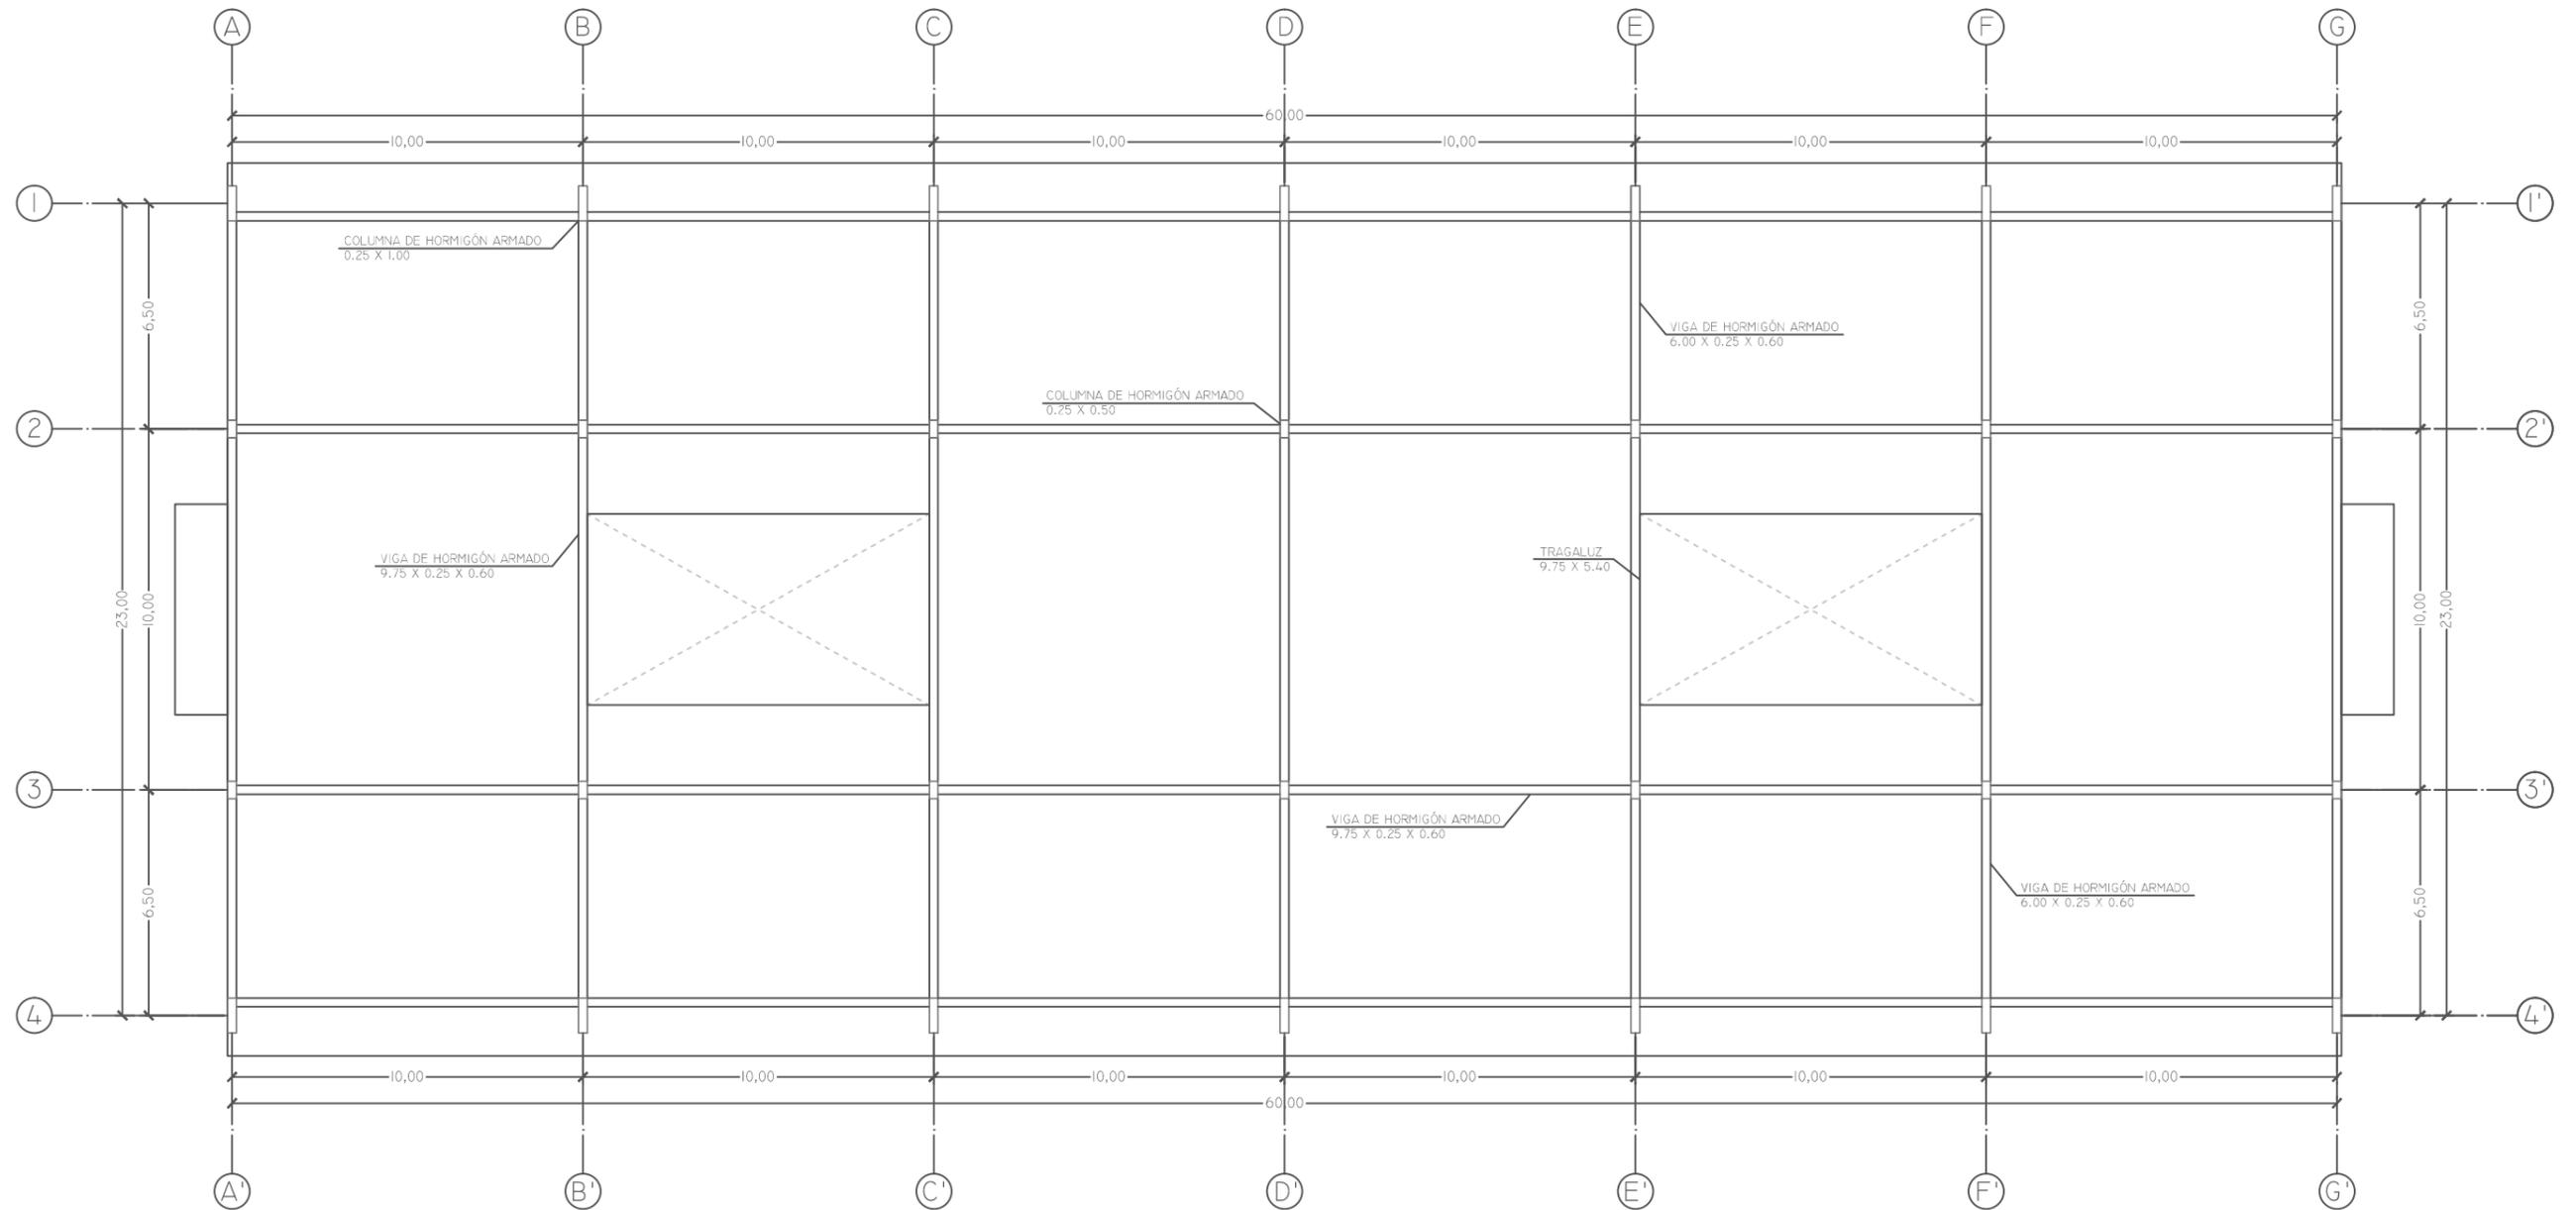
Planta Estructural de Losas de Primer y Segundo Piso
